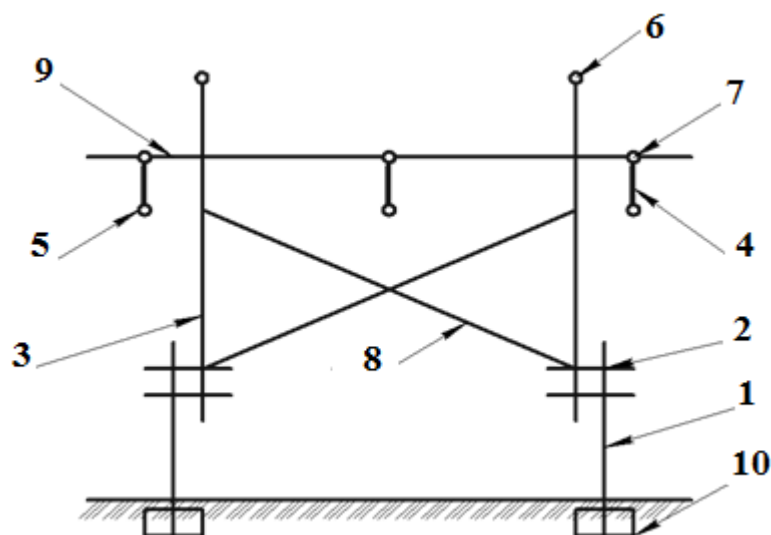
Общий вид П-образной деревянной опоры: 1 – пасынки (ж/б); 2 – бандаж из отожженной проволоки; 3 – стойка; 1+2+3 – нога; 4 – гирлянда изоляторов; 5 – провода; 6 – грозозащитный трос; 7 – арматура; 8 – раскосы; 9 – траверса; 10 – ригели для устойчивости опоры
